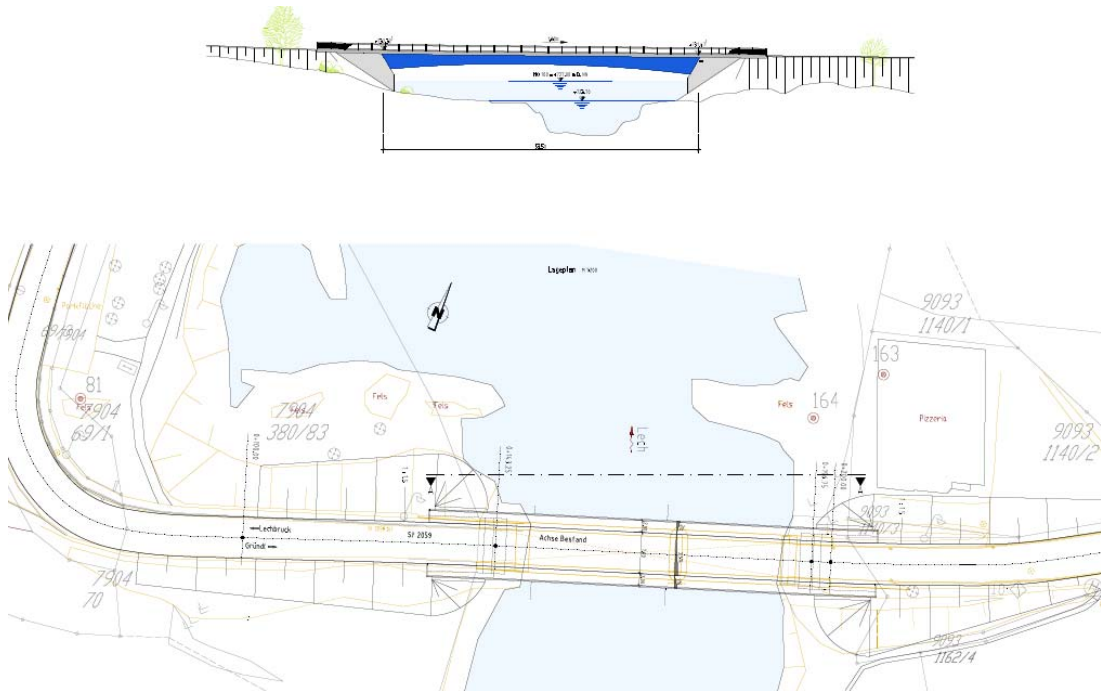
Variante 1a und 1b in Grundriss und Ansicht
